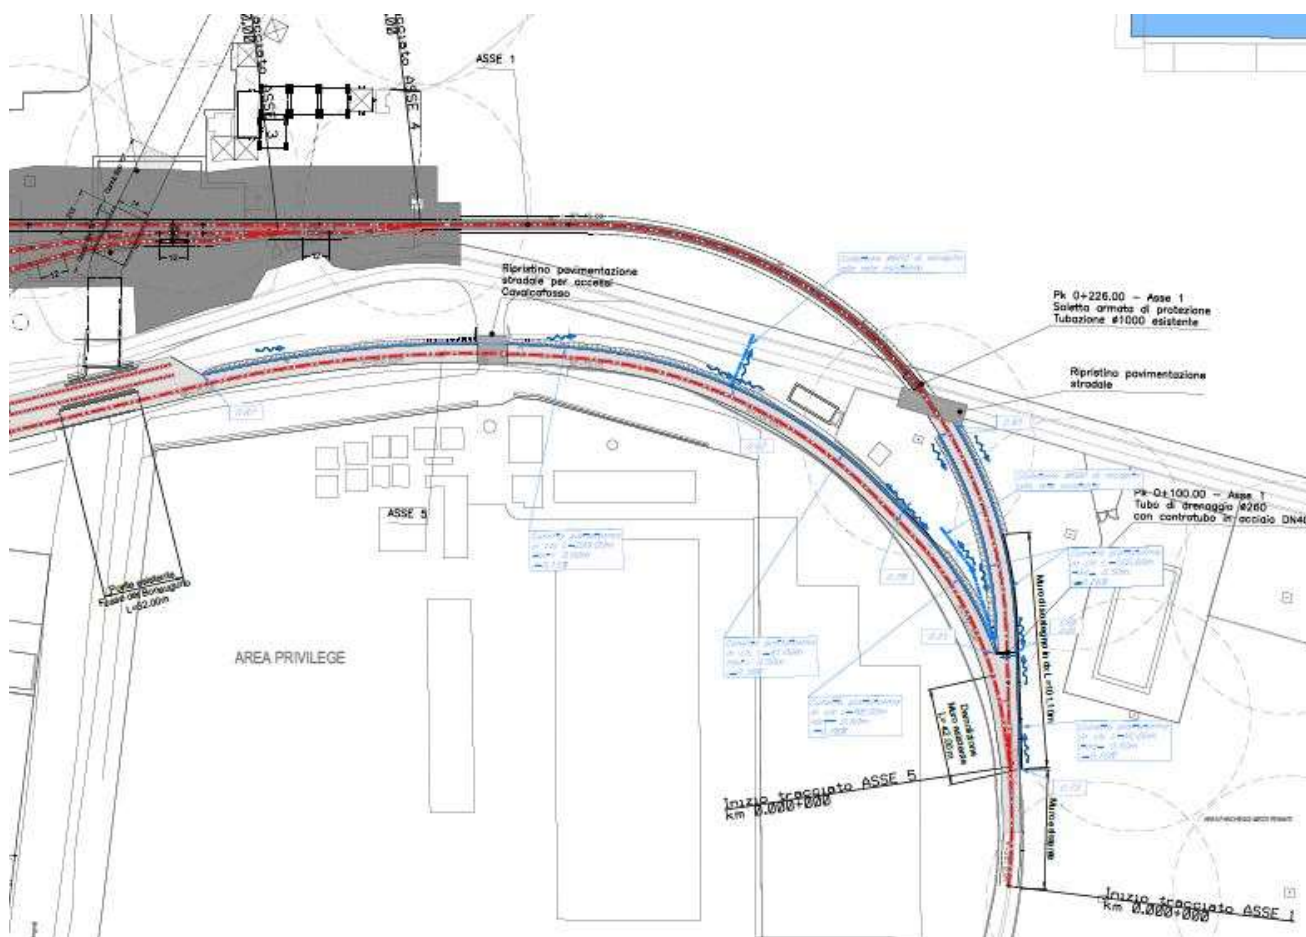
Stralcio Plan idraulica area sfiocco Asse 1 - Asse 5
